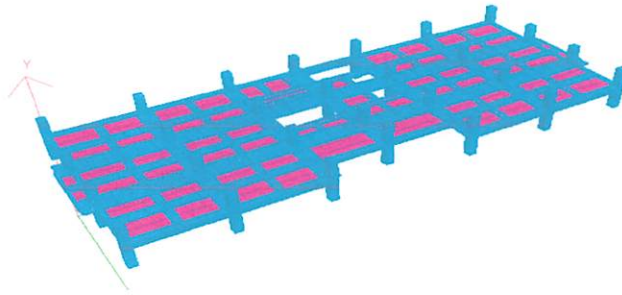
Pemodelan struktur lantai 6 pada STAAD Pro
